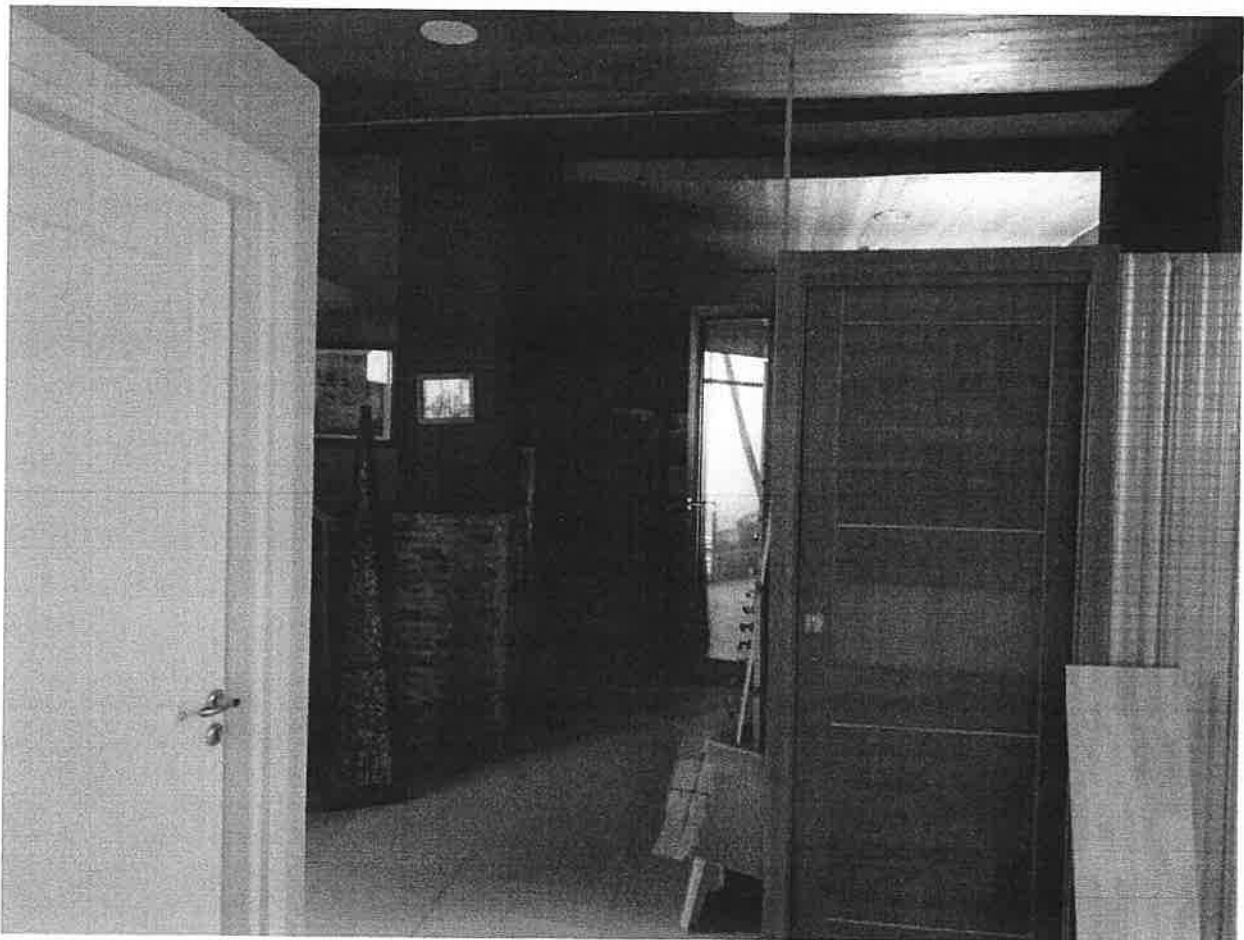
zona d'ingresso dell'esposizione (dal lato della porta di accesso)
